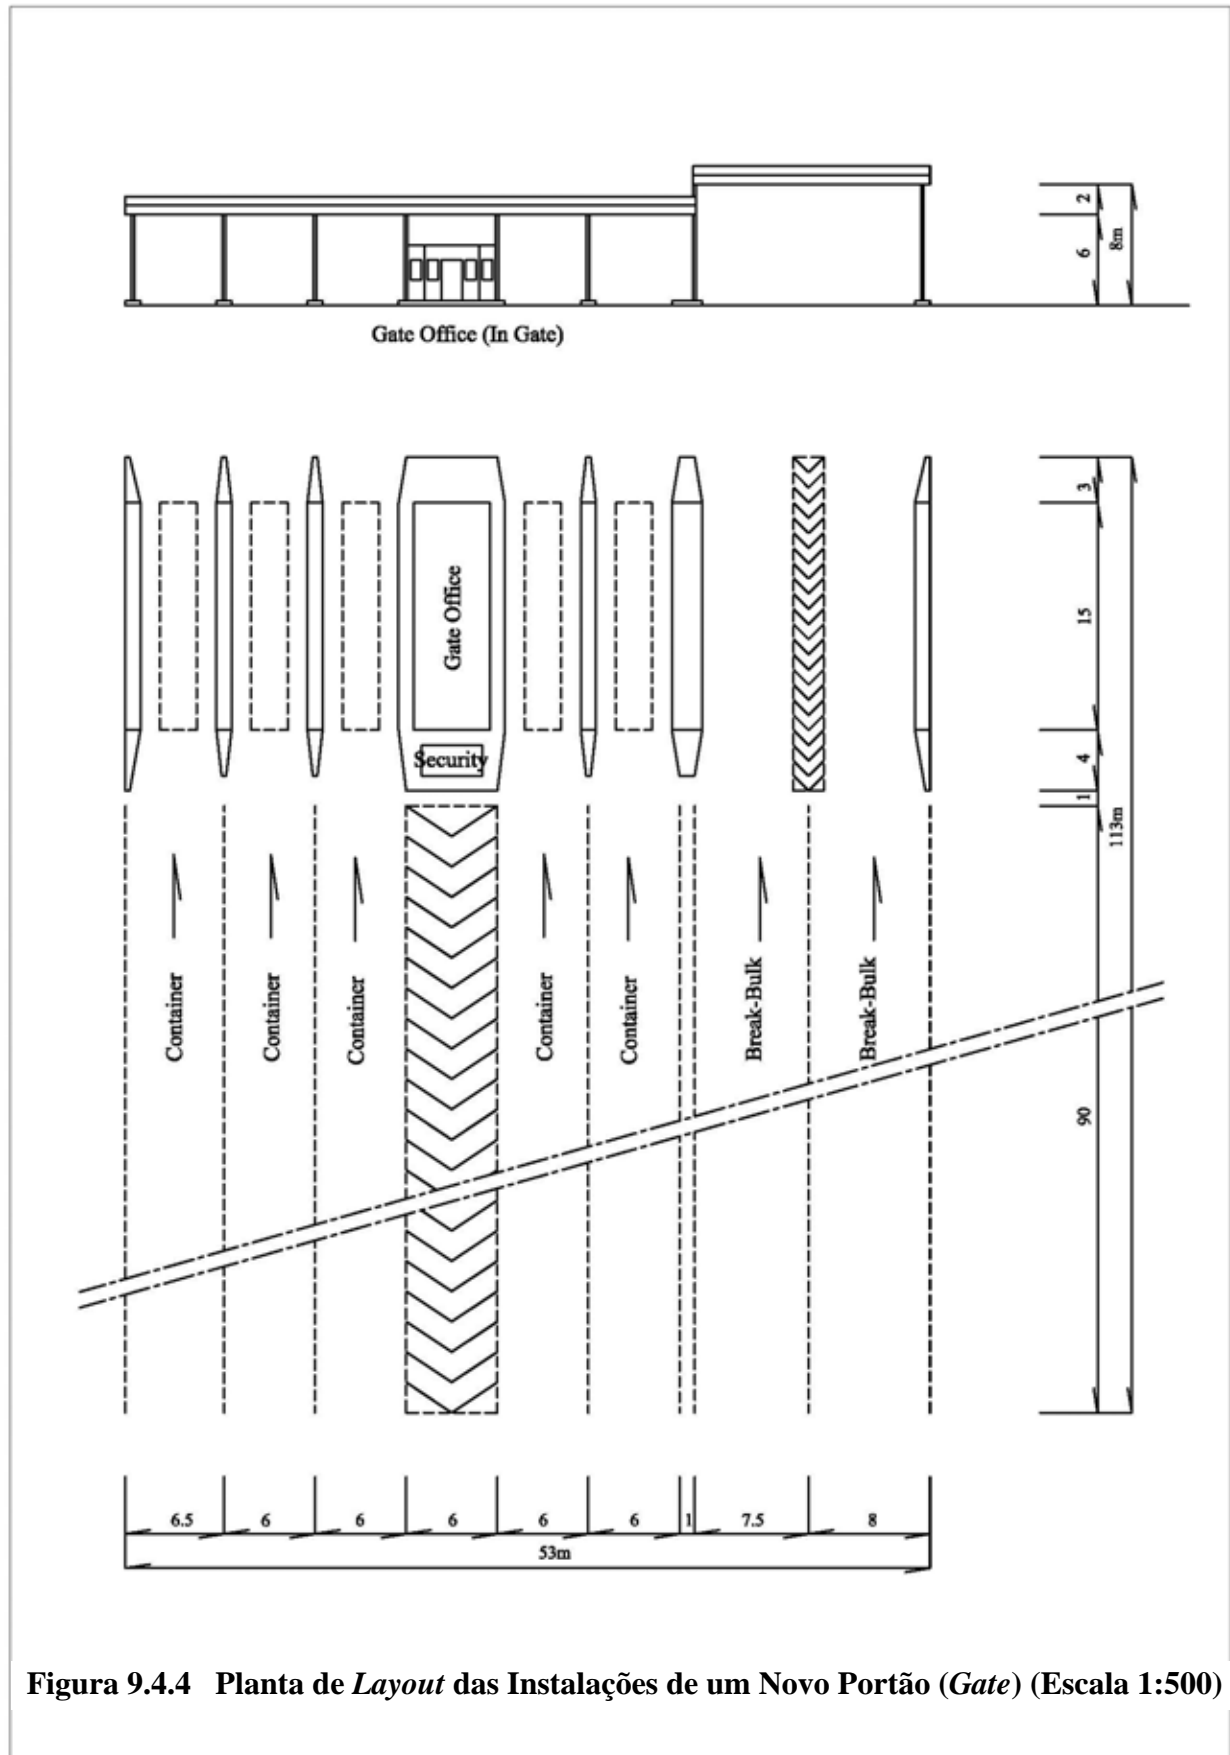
Planta de *Layout* das Instalações de um Novo Portão (*Gate*) (Escala 1:500)
